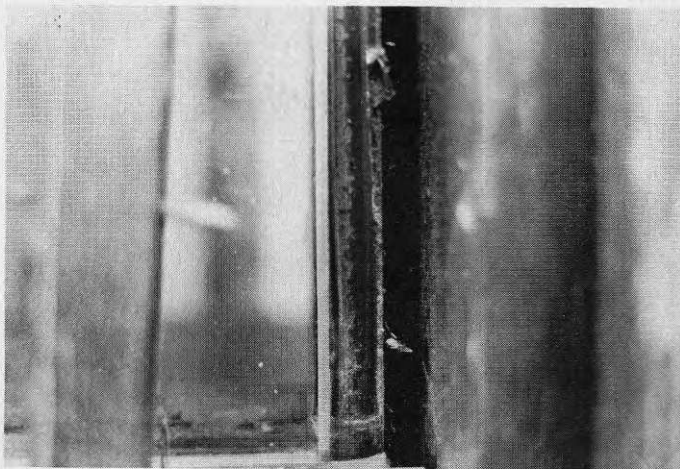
Adhesiva släpp mellan kantförsegling och glas.
